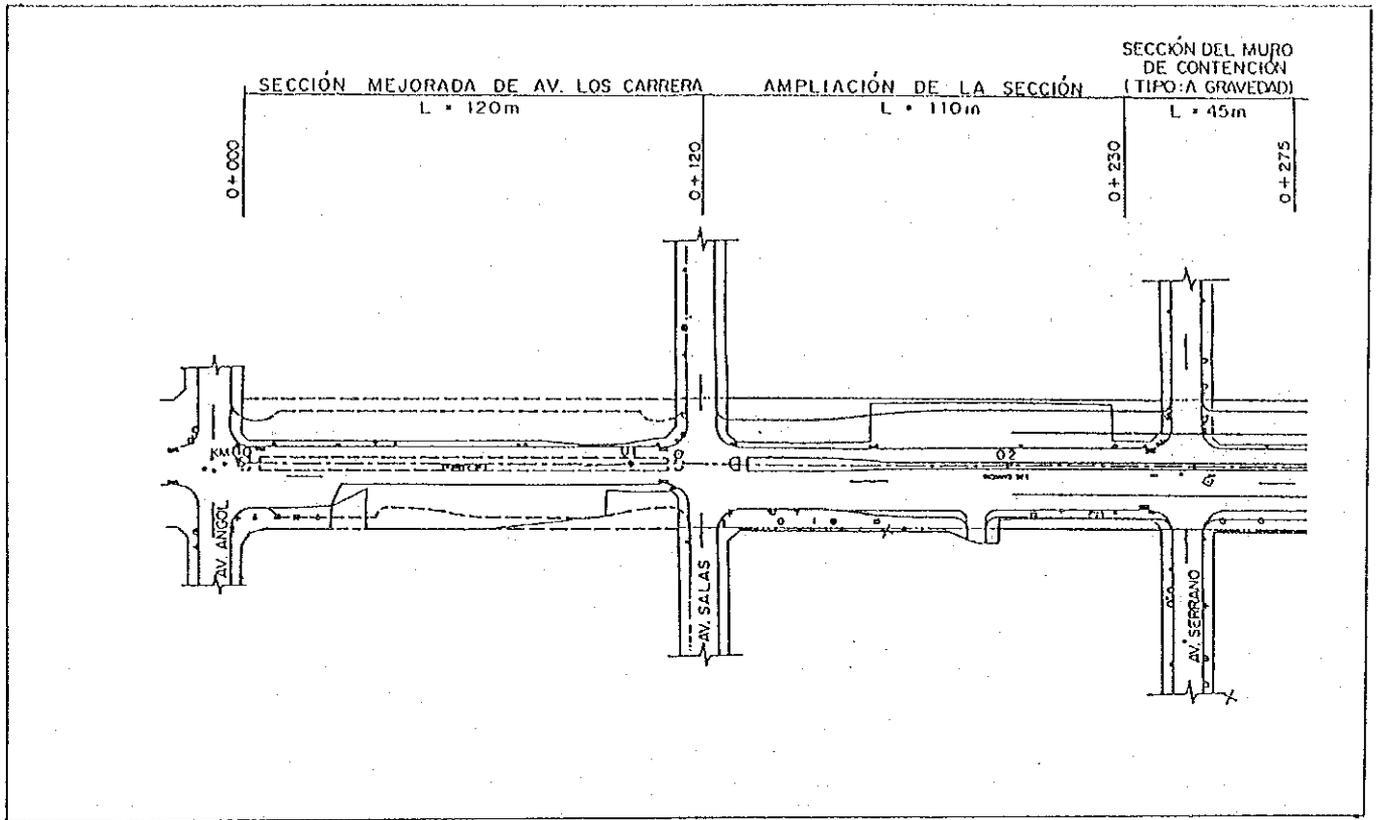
Plan de Mejoramiento de la Av. Los Carrera
